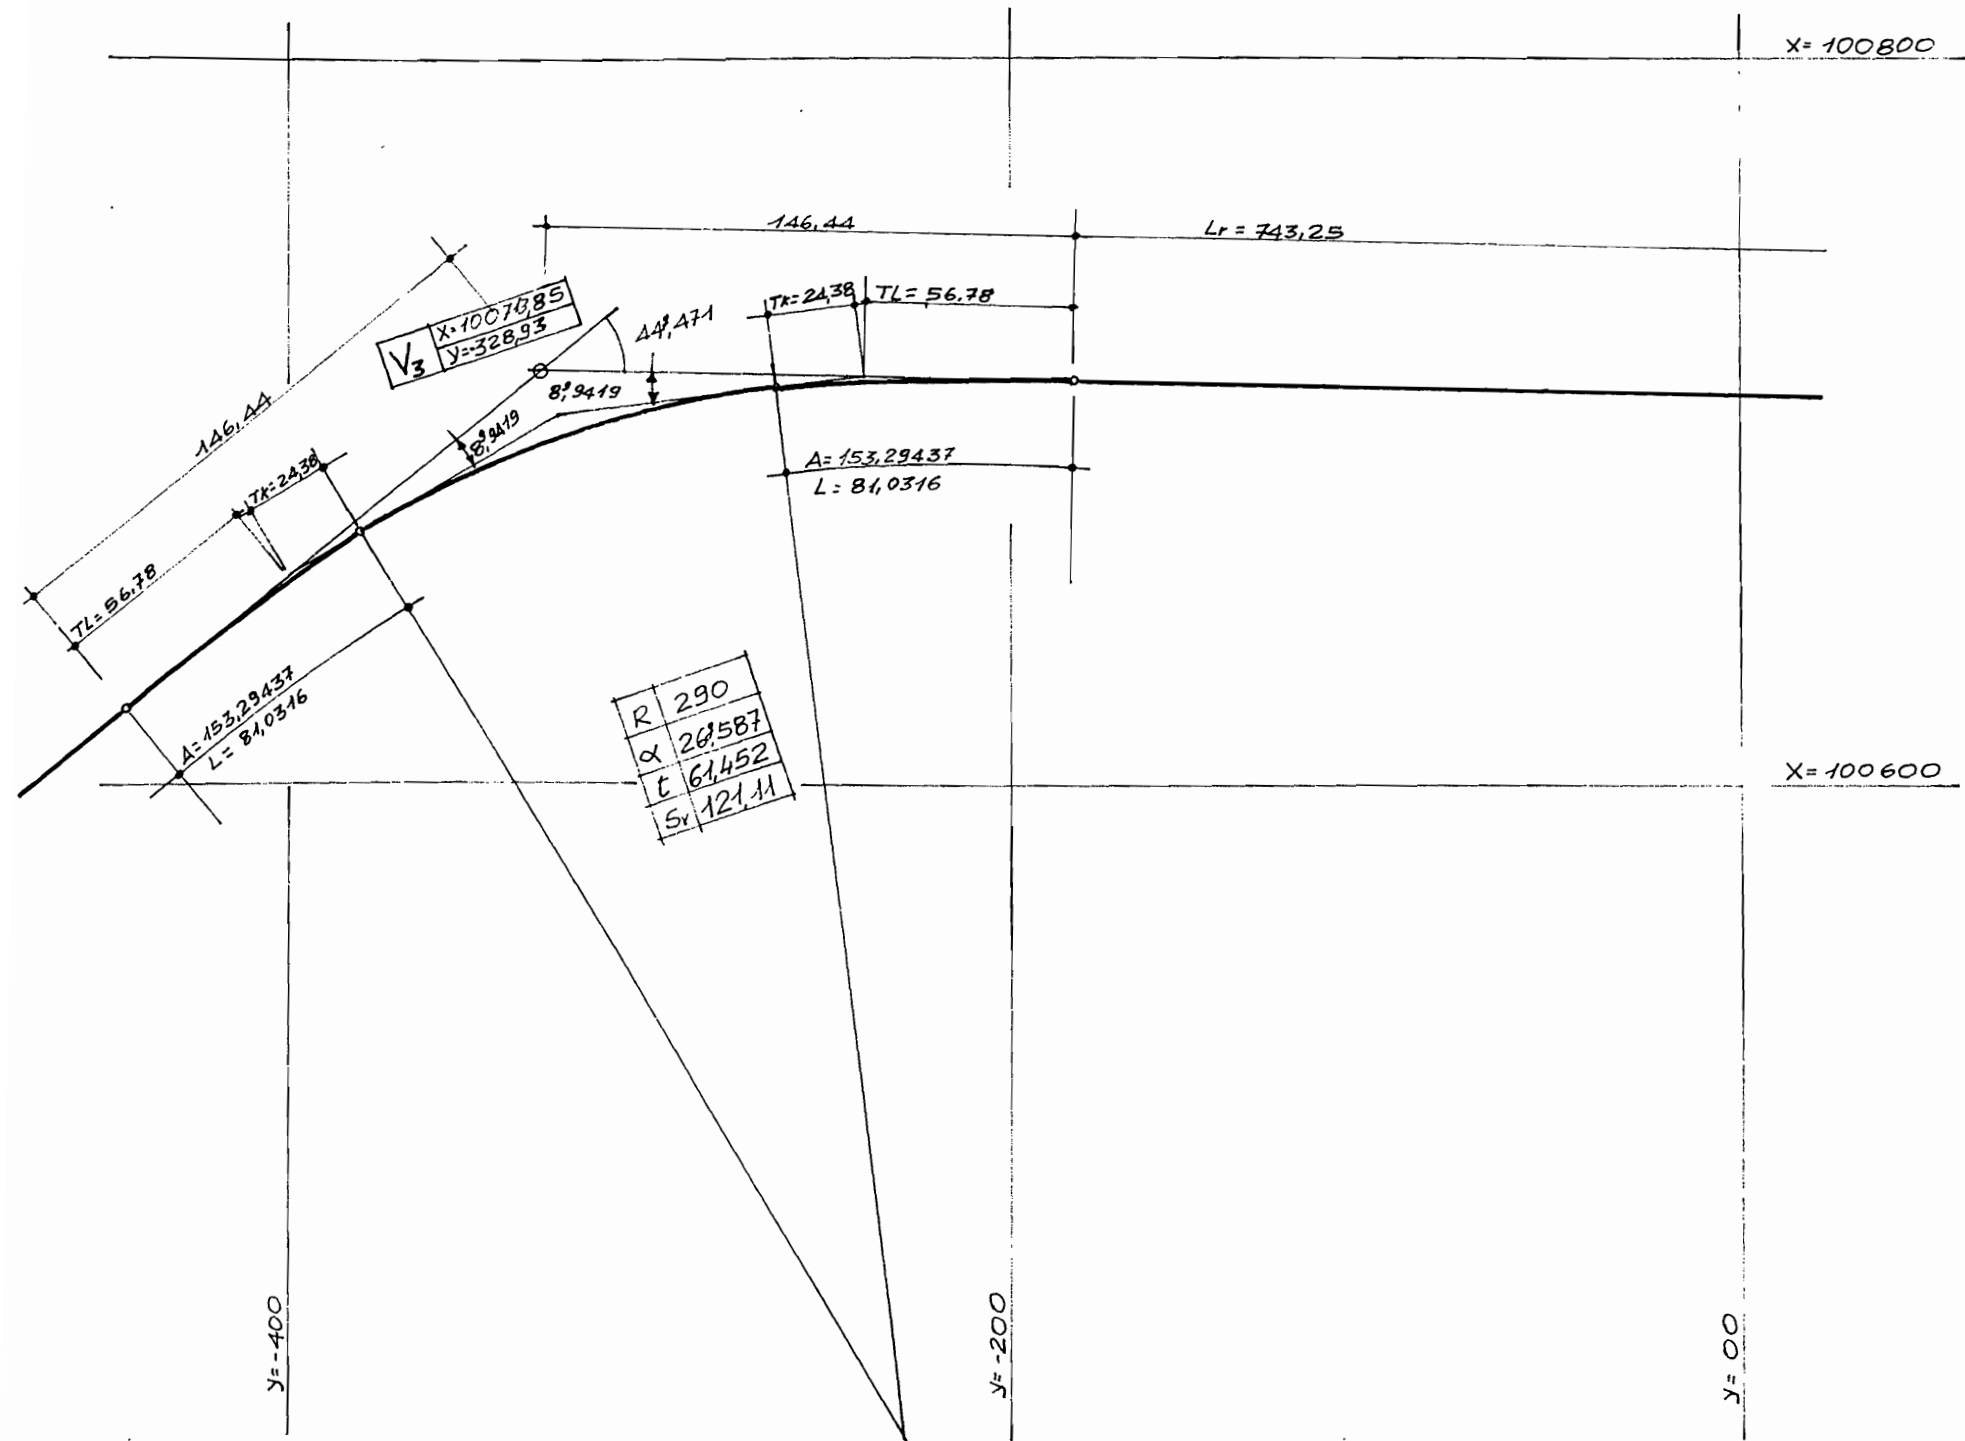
Planimetria in dettaglio per il tracciato di un tratto di strada.
